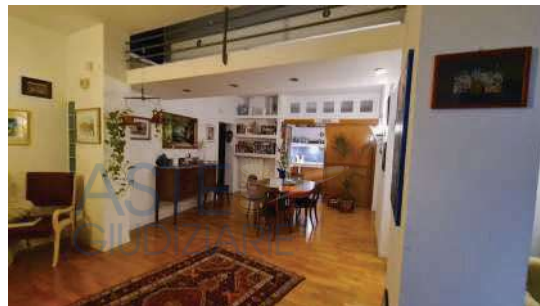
Sogg./pranzo-particolare soletta di collegamento soppalco-vano letto p. terzo
